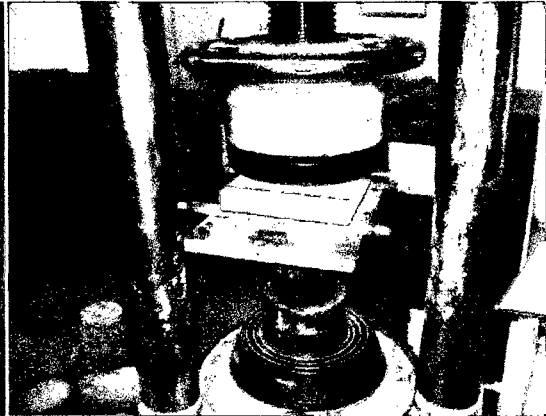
Placas ensayadas a flexión con la prensa hidráulica
